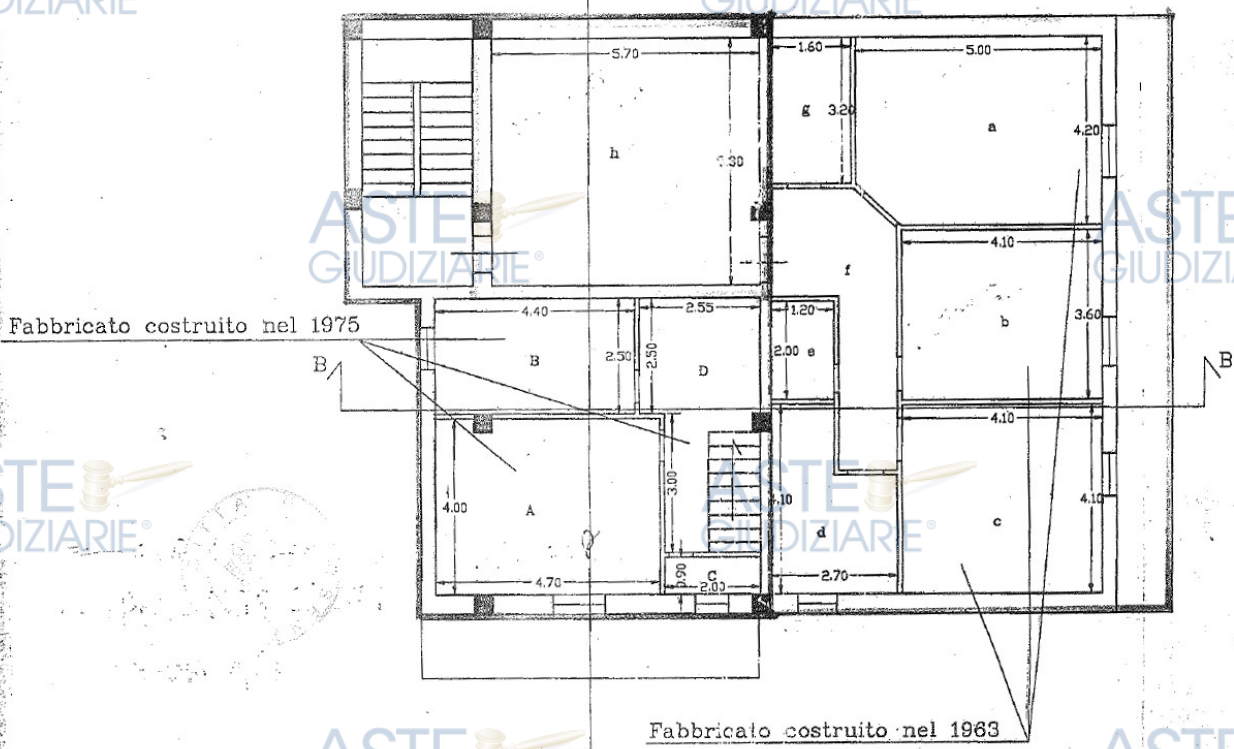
Planimetria in integrazione alla domanda di condono - Piano primo.
